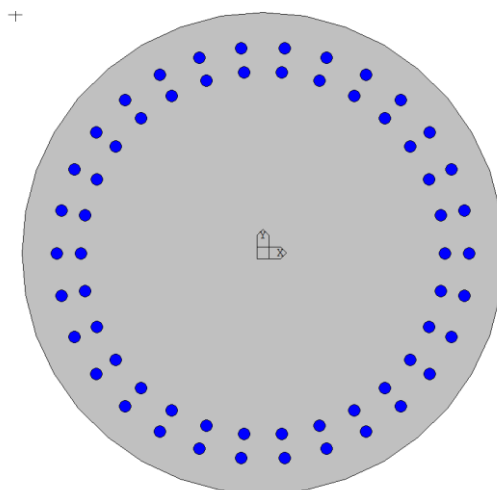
Disposizione armatura longitudinale palo di fondazione
